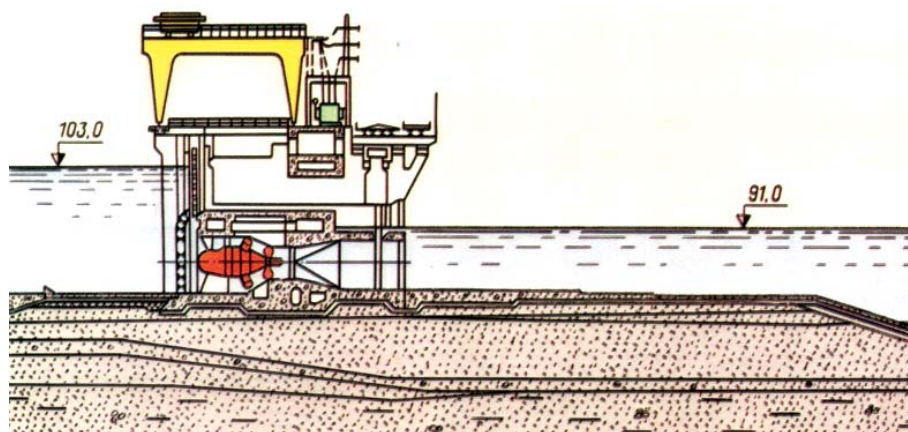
Поперечный разрез по зданию Киевской ГЭС
